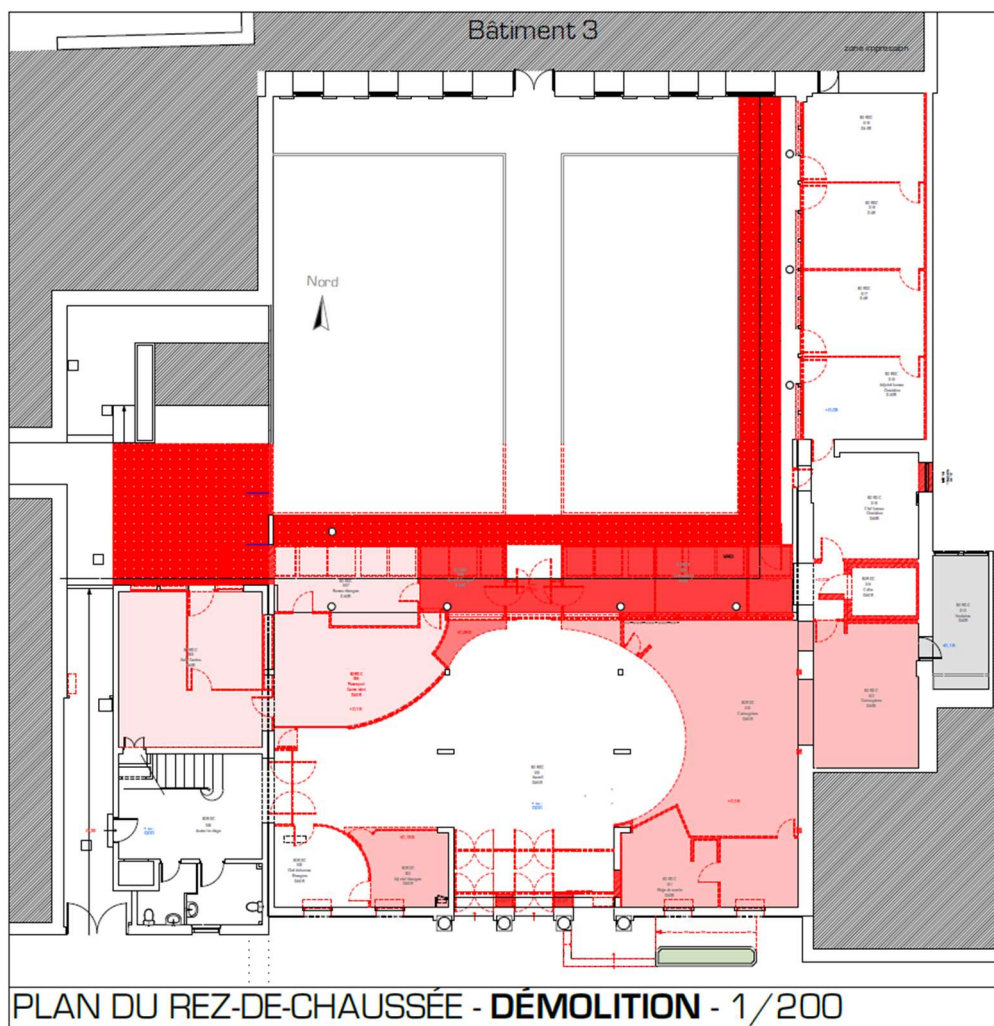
Plan du rez-de-chaussée - Démolition - 1/200
